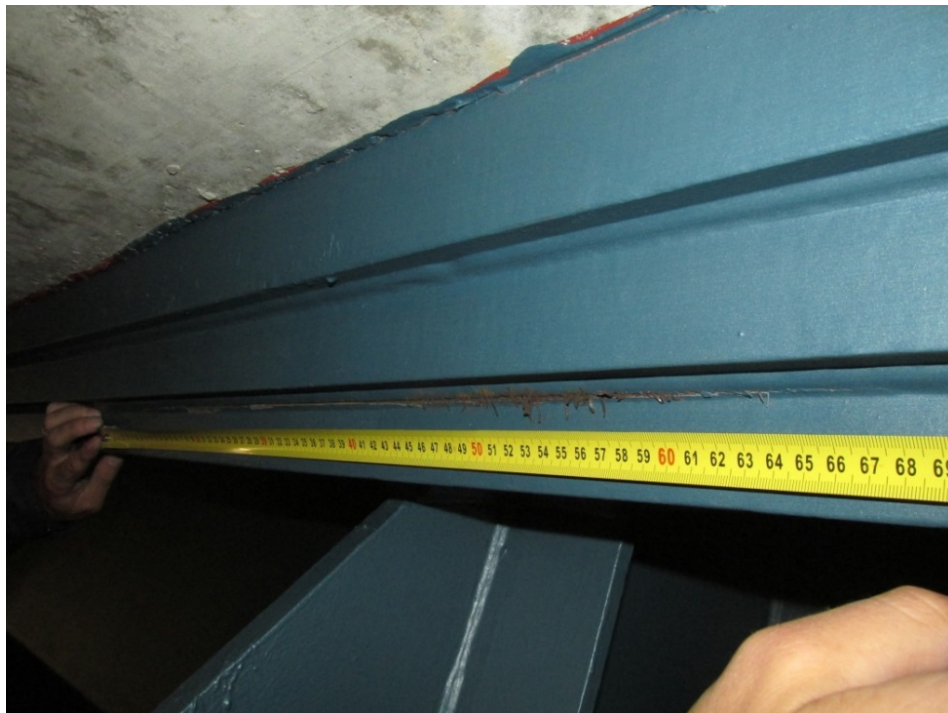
Riss zwischen den Lamellen der Stahloberggurte der Hohlkastenstege (Quelle: HP 2014 Dr. Löber IGV mbH, Halle)
